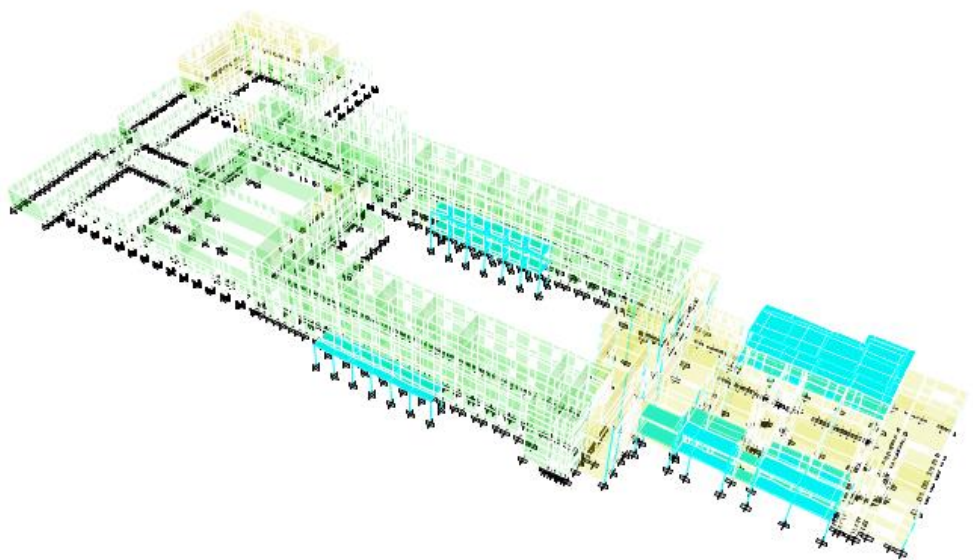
Shtesat b/a ne raport me strukturen (objektet ne blu)
